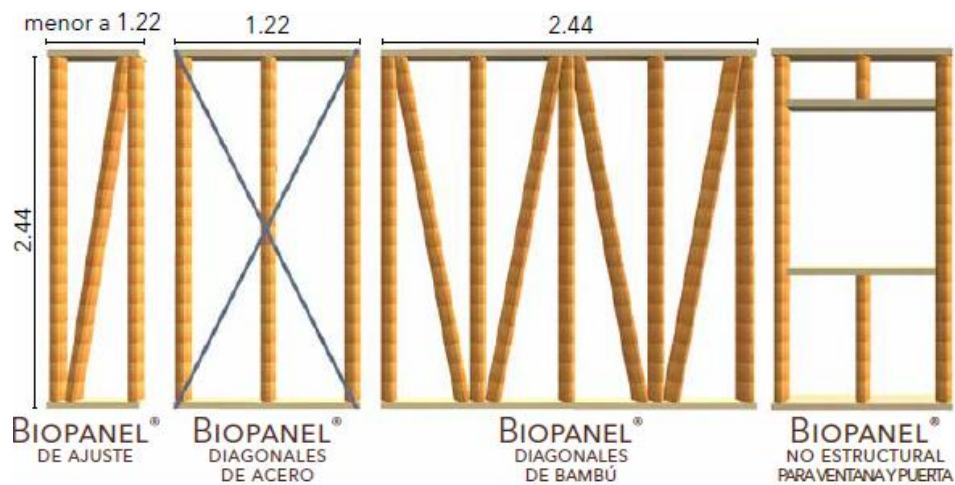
Biopanel. Fuente Sistema Constructivo BiBa.
